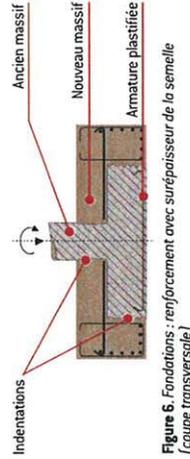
Fondations : renforcement avec surépaisseur de la semelle (coupe transversale)
